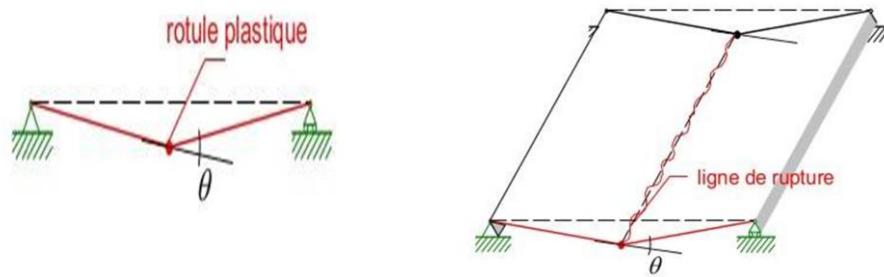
Mécanisme de rupture pour une poutre et une dalle [12].
